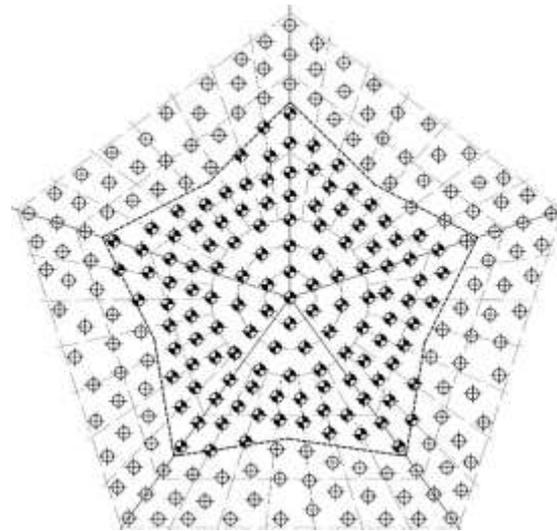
Схема расположения свай в составе фундамента здания «Лахта Центр»
